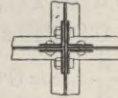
, 252: Grundrisse zu den Fig. 249, 251.
